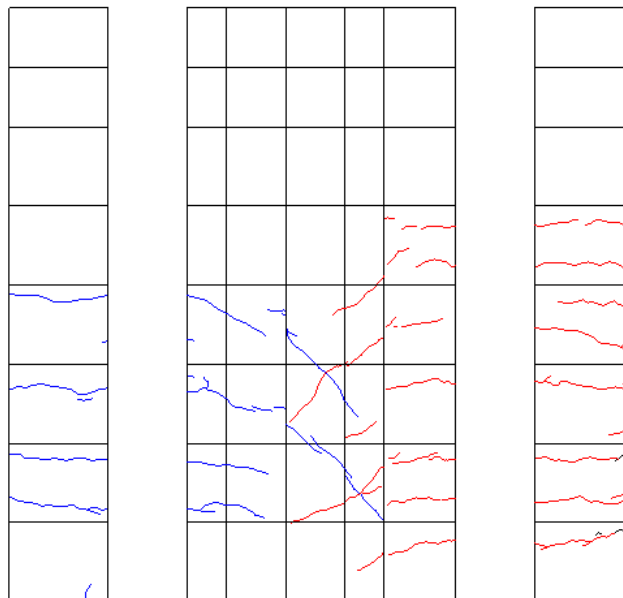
R=-1/400②ひび割れ図
